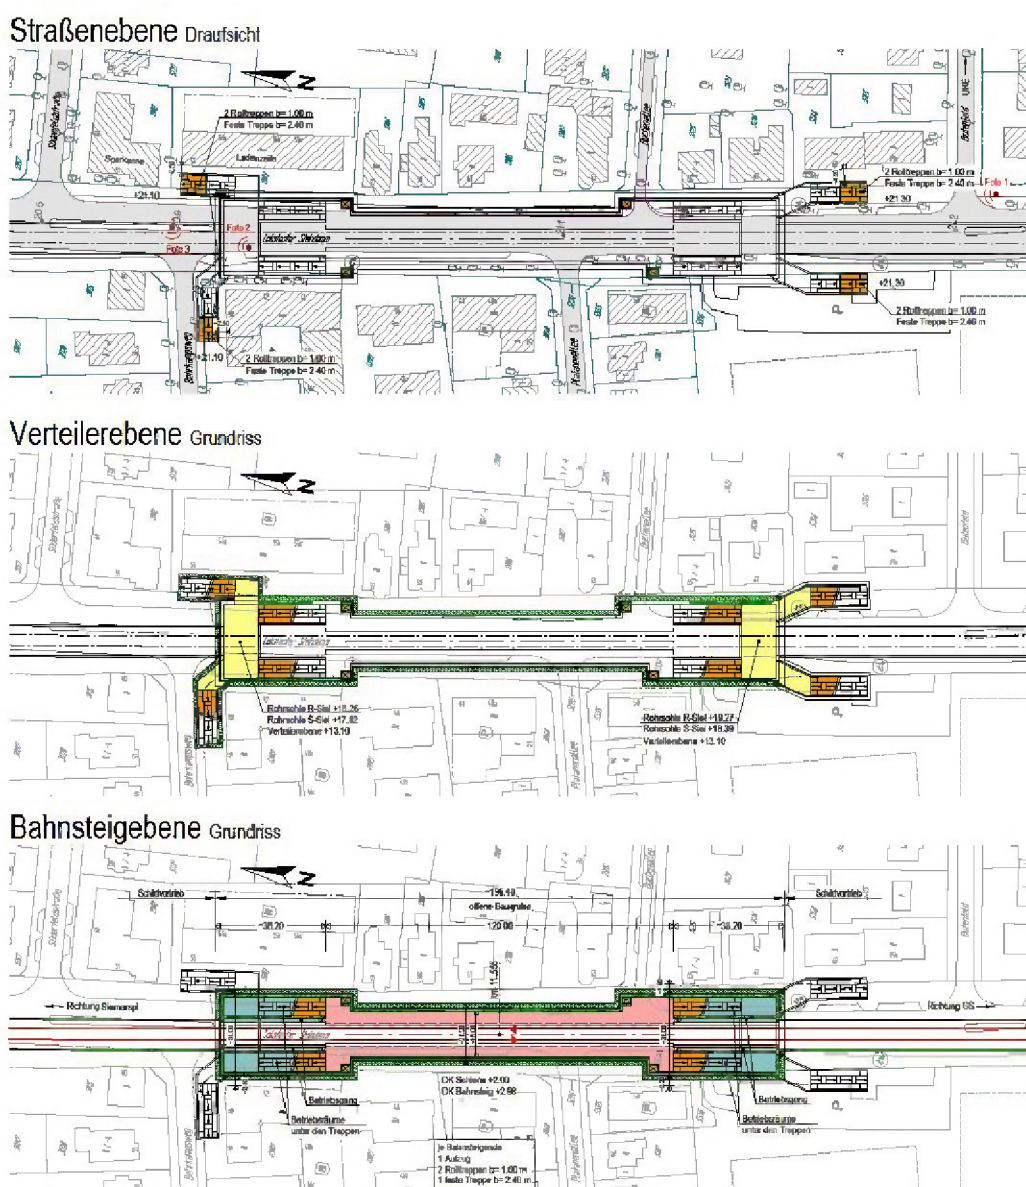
Lageplan Haltestelle Lokstedter Steindamm I
